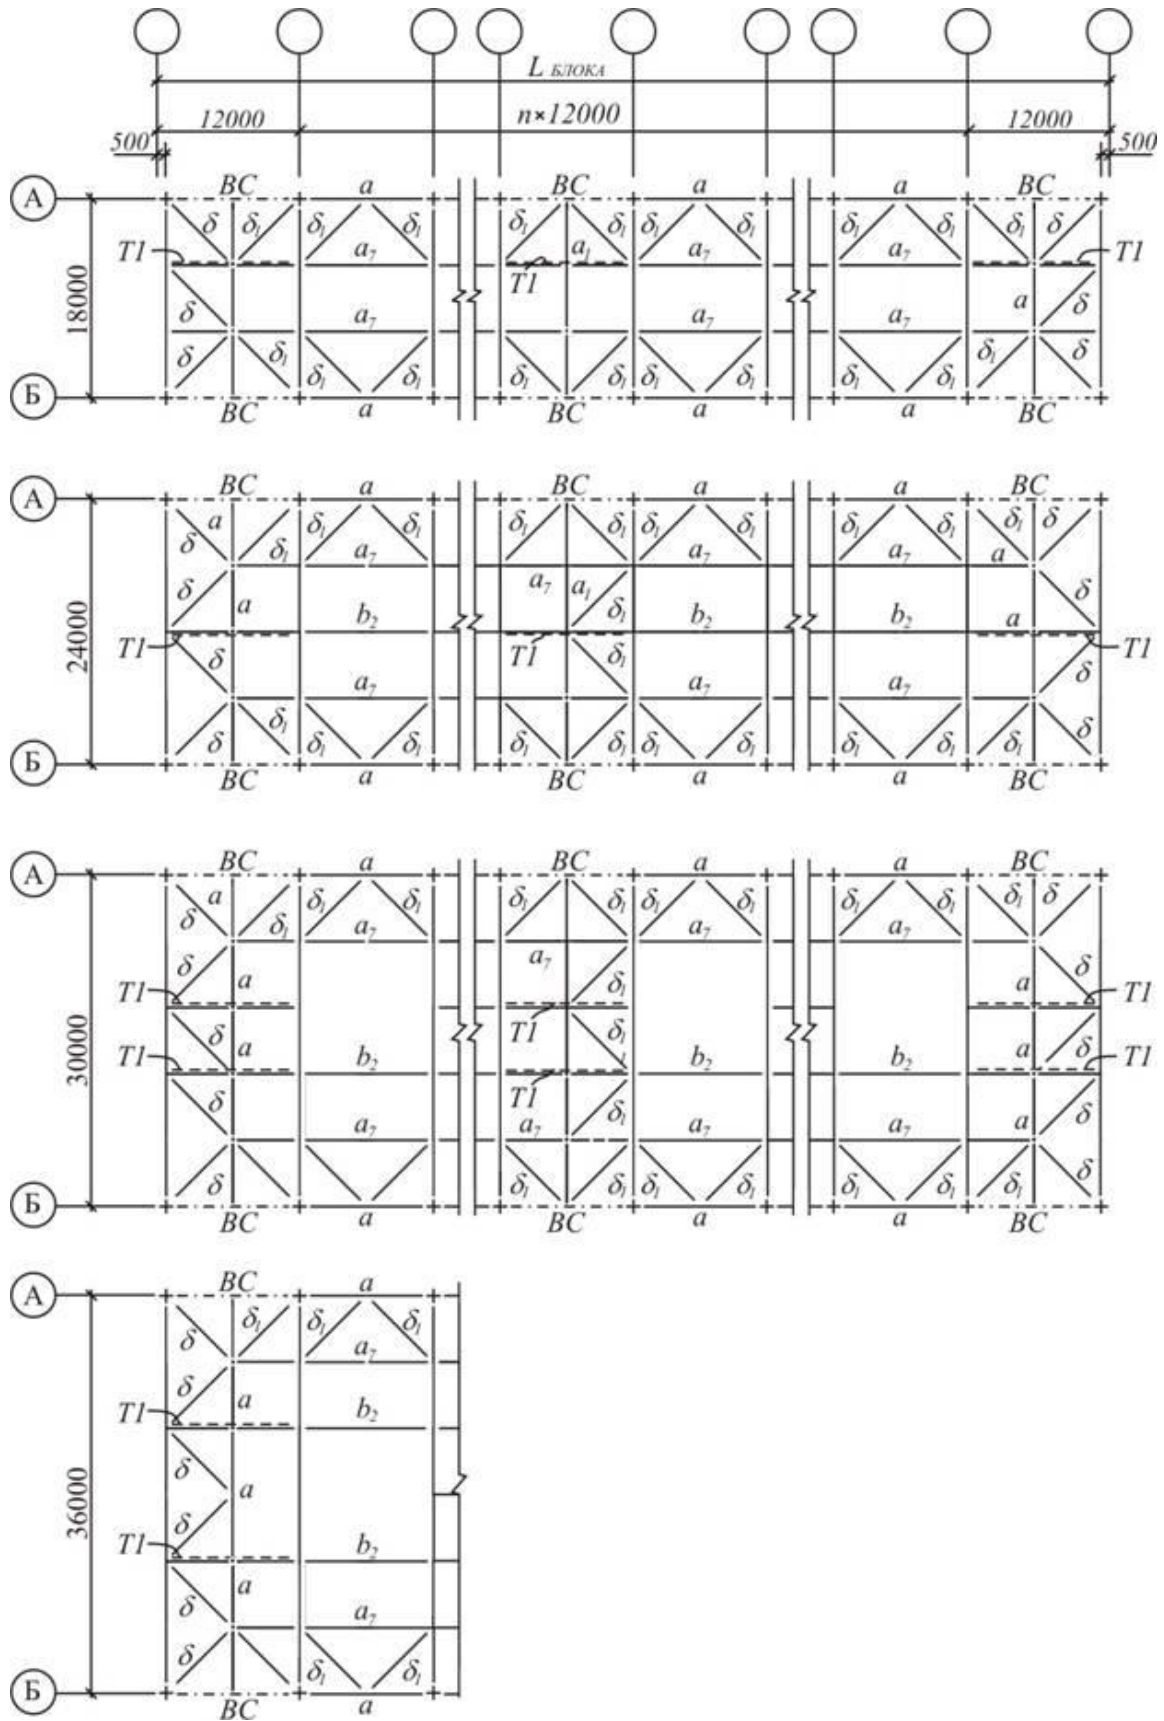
Зв'язки по нижніх поясах ферм, крок ферм – 12 м
